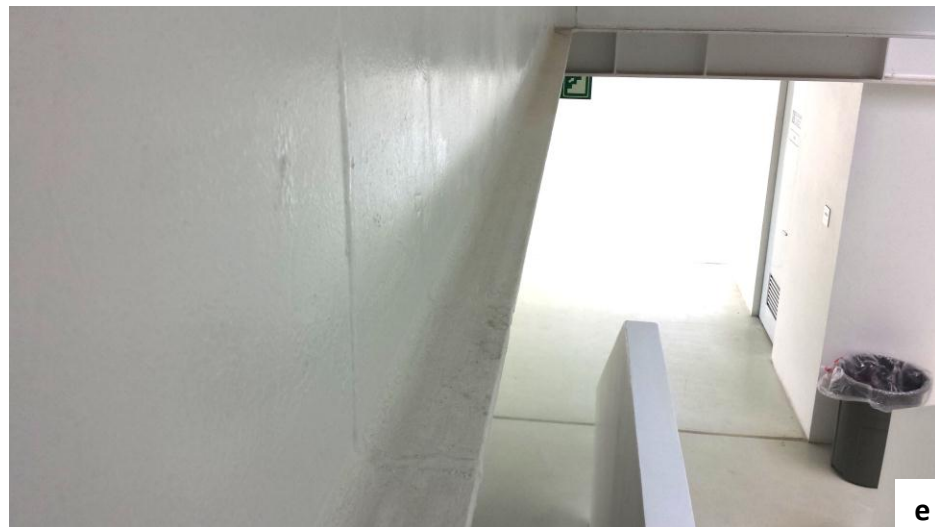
(a) Vigas de la parte exterior del edificio, (b) Vigas de la parte interior del CIA, (c) Tubos de las conexiones eléctricas, (d) Vigas de soporte, (e) Vigas de la parte inferior de los pisos.
